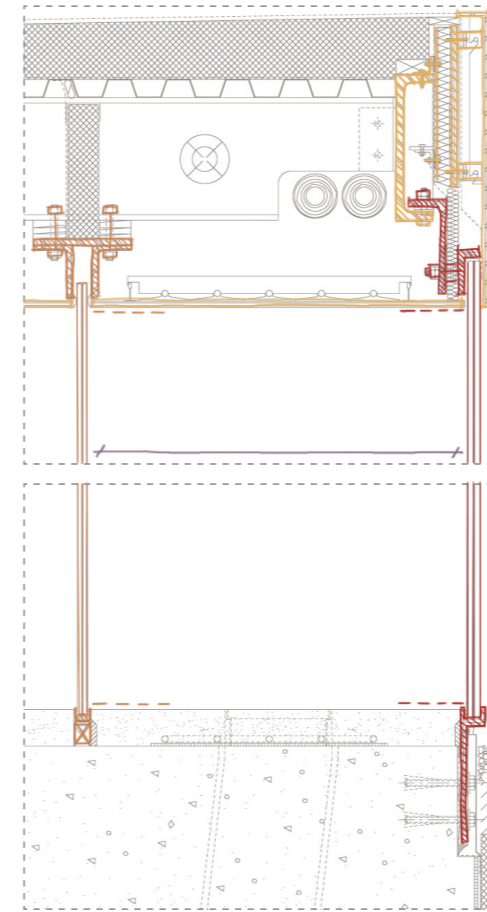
Detalle constructivo pabellón de vidrio del museo de arte de Toledo. Cerramiento externo.
